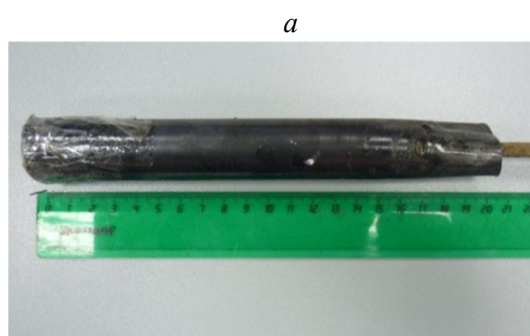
Конструкция анкерной муфты для испытания композитной арматуры на растяжение:
